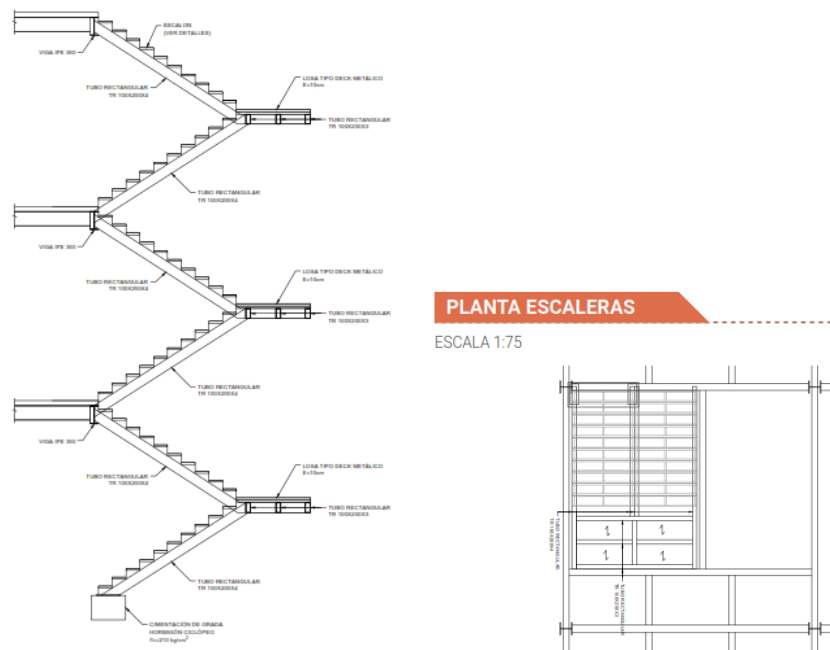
Detalle en planta y corte de escaleras (Gualavisí N., 2022)
